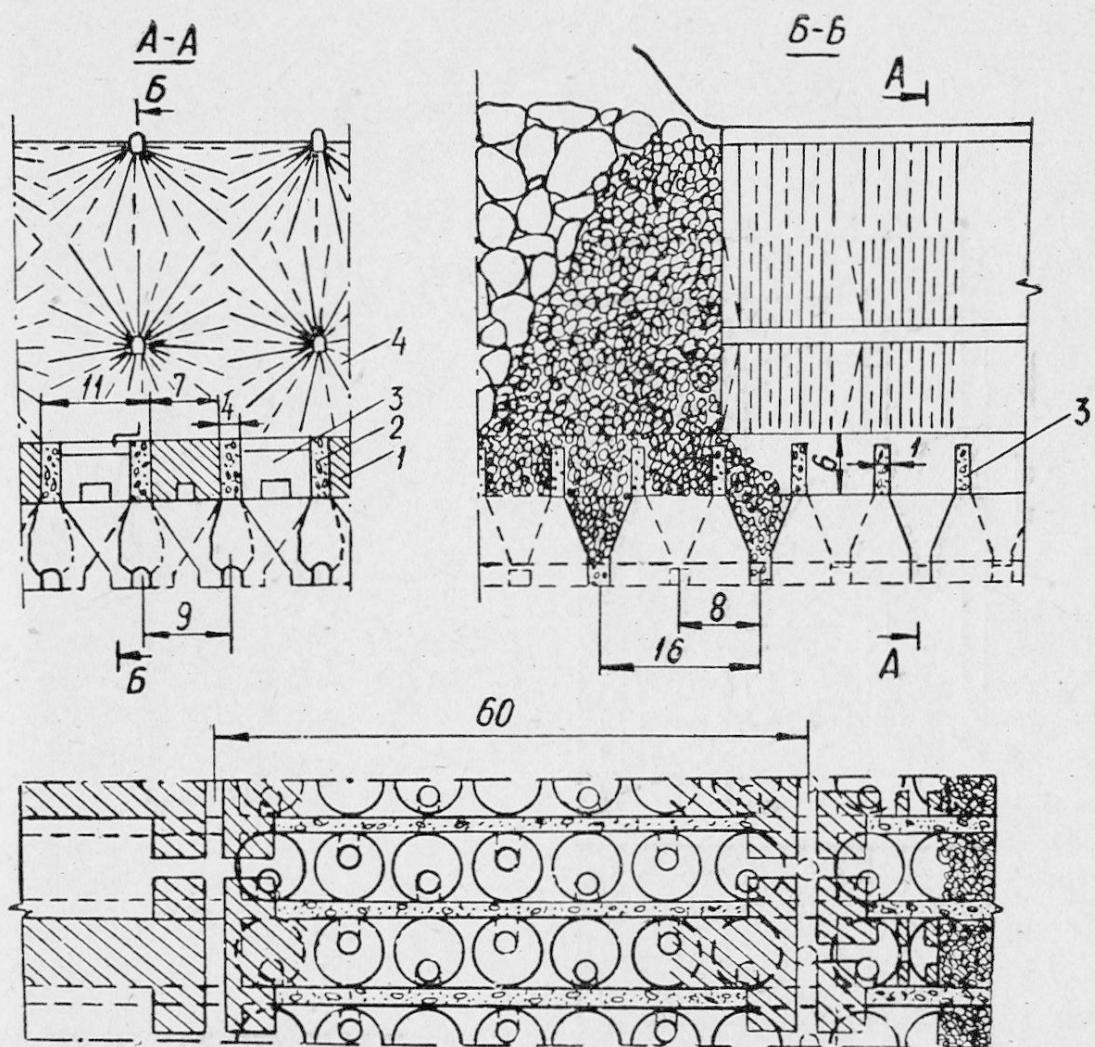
Вариант системы последующей разработки пологопадающих месторождений: 1 — целики богатой руды; 2 — подпорные бетонные стенки; 3 — бетонные перемычки; 4 — бедные руды
